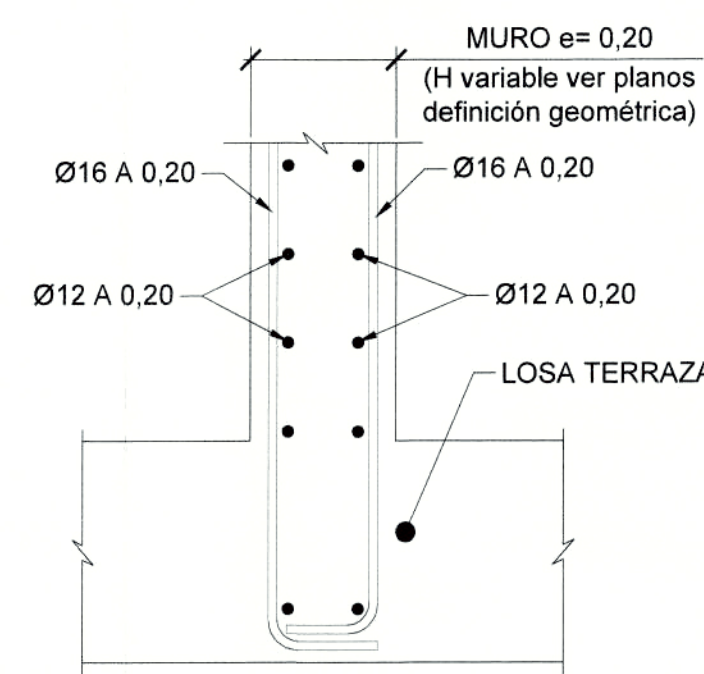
Y 3 CUBIERTA Y MURO SOPORTE CUBIERTA
